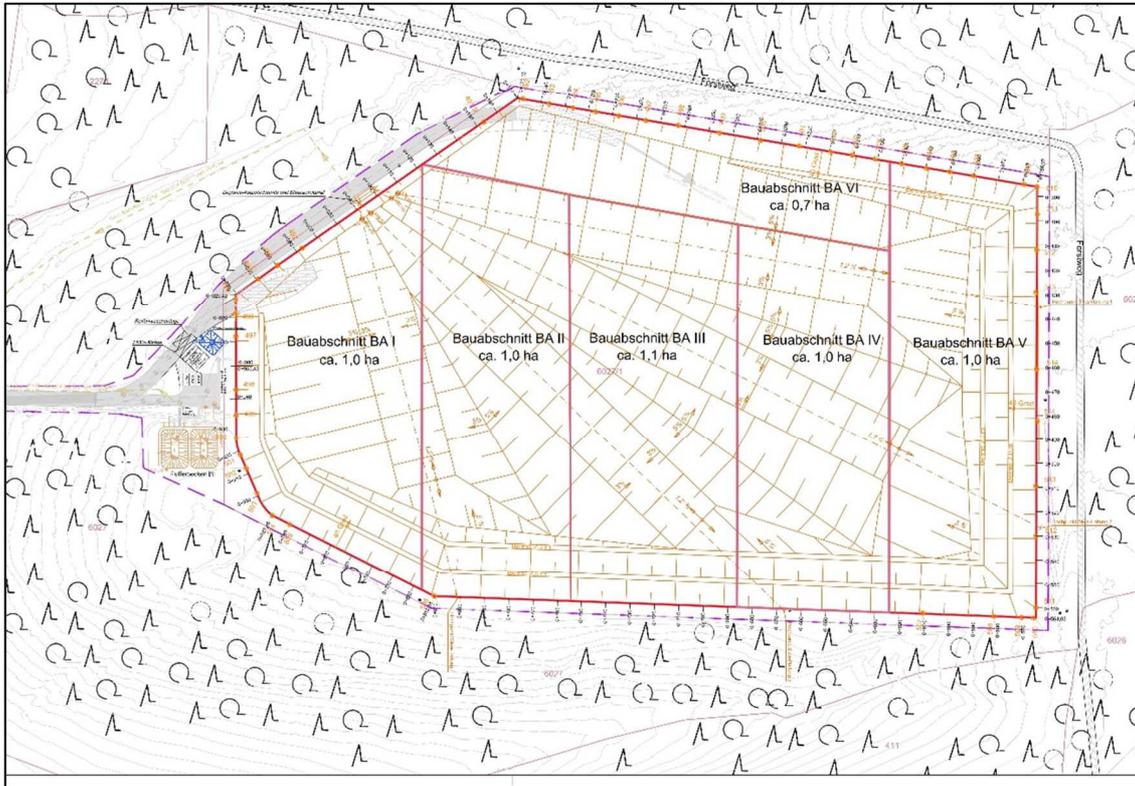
Lageplan der geplanten DKI-Deponie mit den Verfüllabschnitten und Zufahrt
